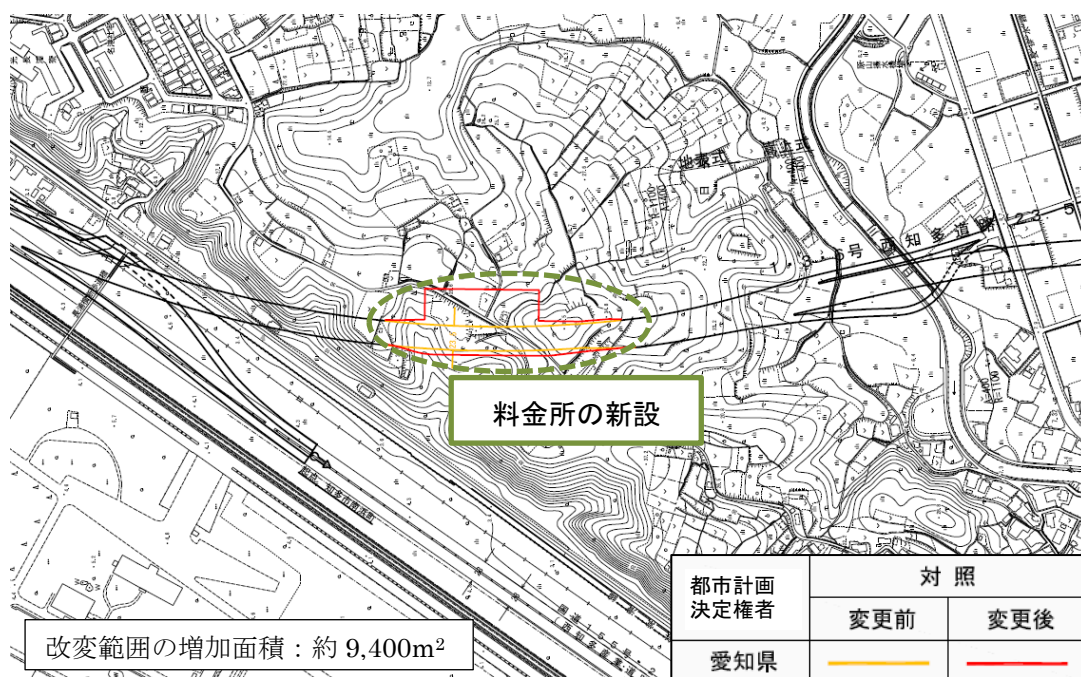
(4) 事業計画の変更前後の平面図 (日長料金所)
